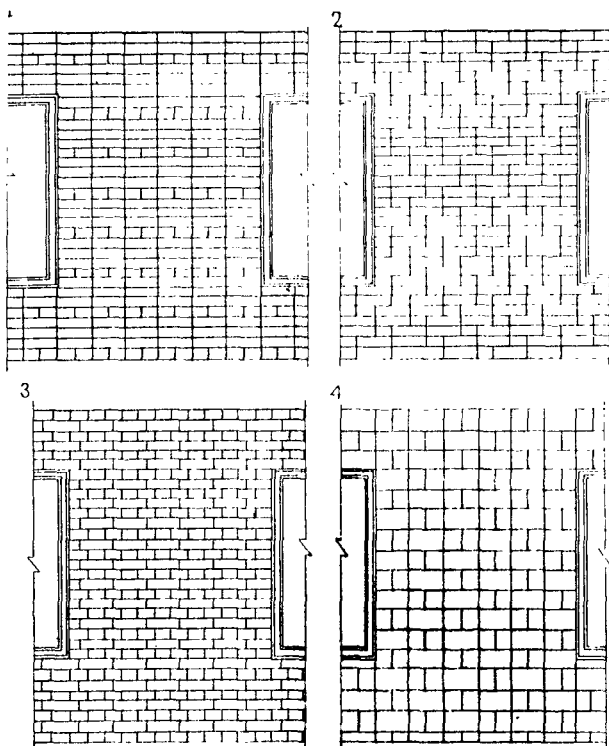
Примеры декоративной облицовочной кладки фасадных стен
